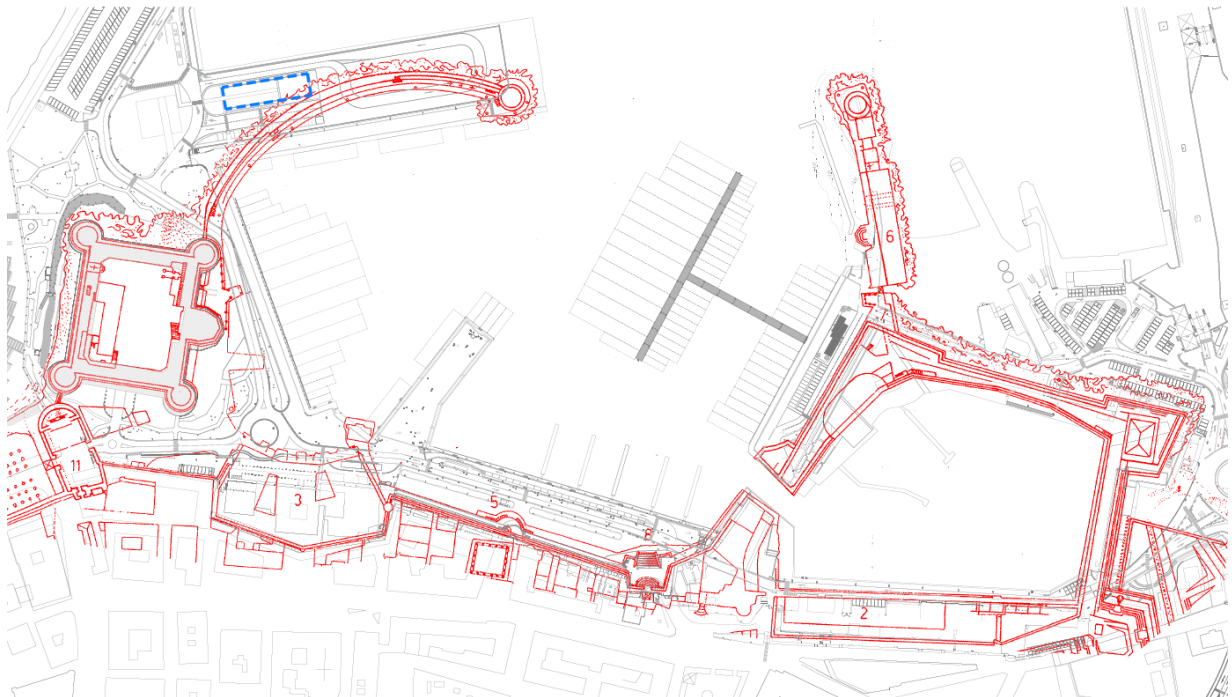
Sovrapposizione impronta fabbricato Molo del Bicchiere
